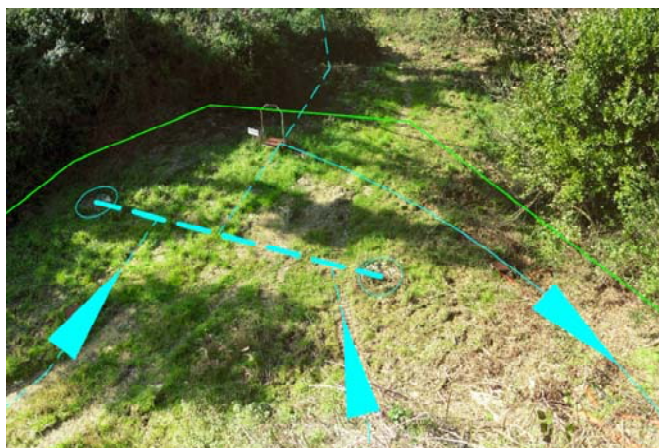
Sottoservizi zona R-S, trincea drenante terre armate
